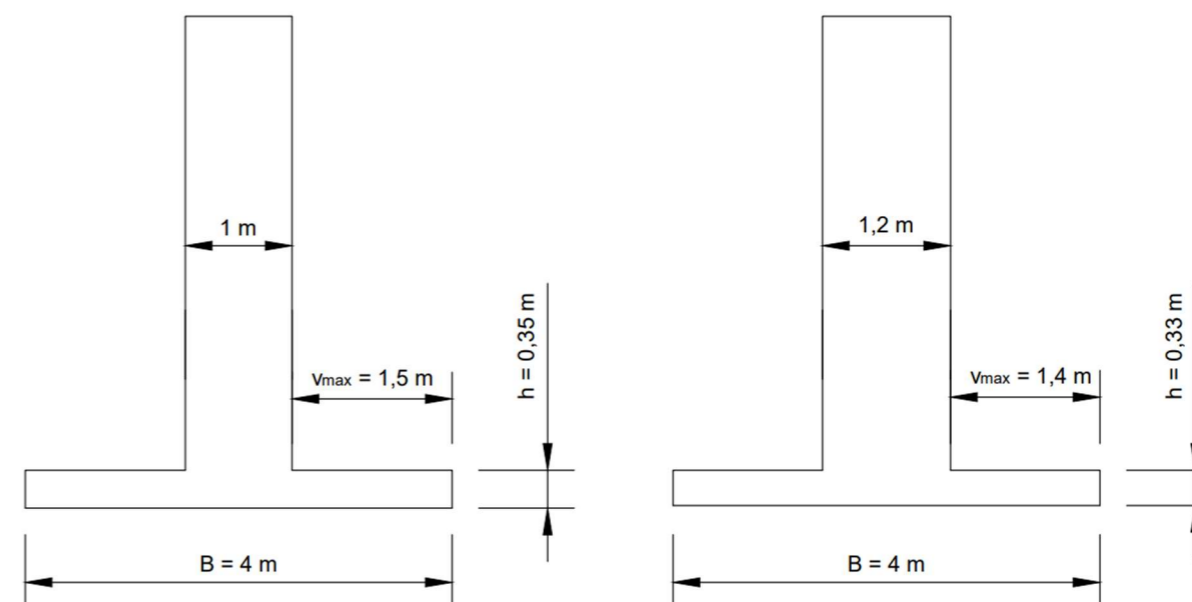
Geometría de pilas para el dimensionamiento de una zapata rígida con canto mínimo.
